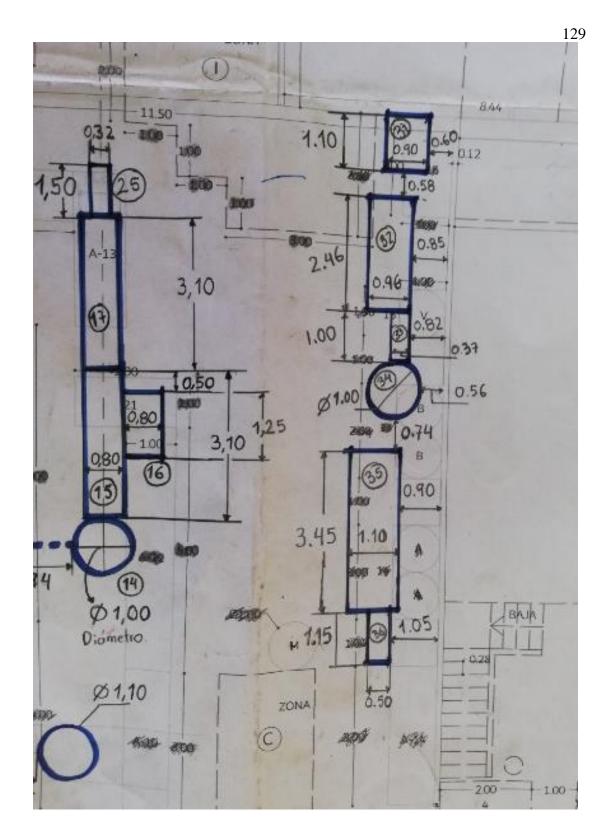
Reubicación de la maquinaria para la zona de etiquetado. (Fuente: Autor).
